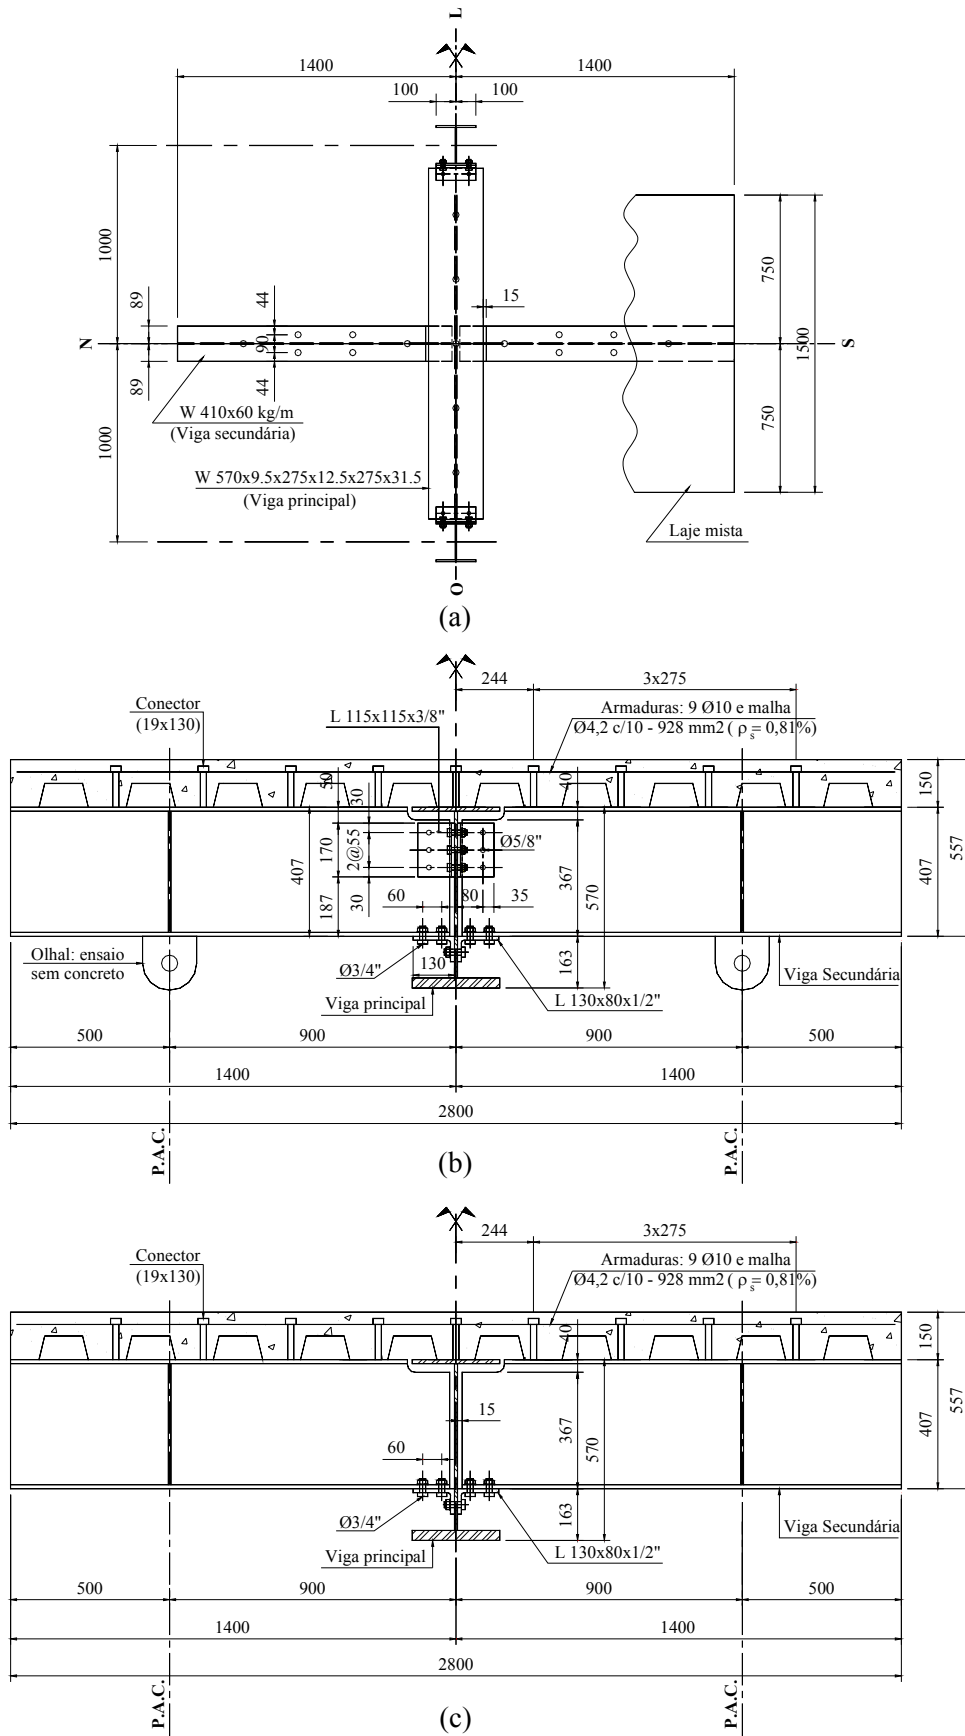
Ligações do grupo 1: (a)Vista superior; (b)Ligação 1(a); (c)Ligação 1(b).
